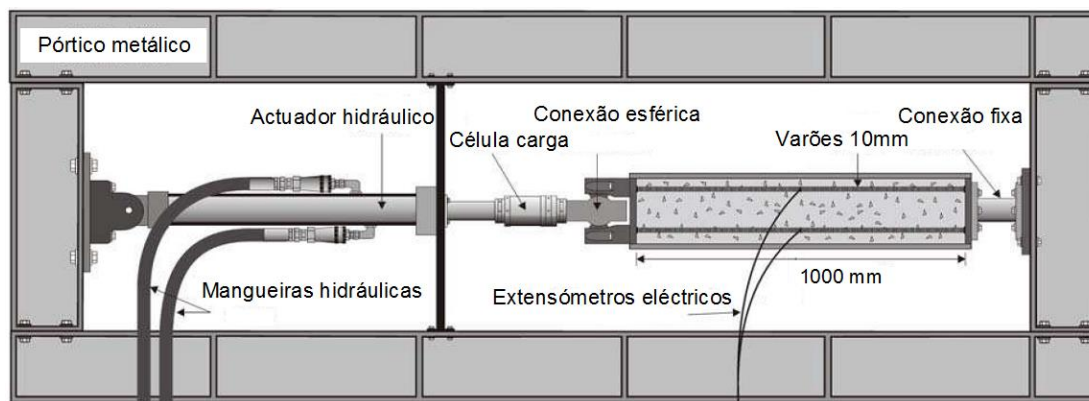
Ensaio de restrição longitudinal realizado num provete armado (adaptado de [30]).
